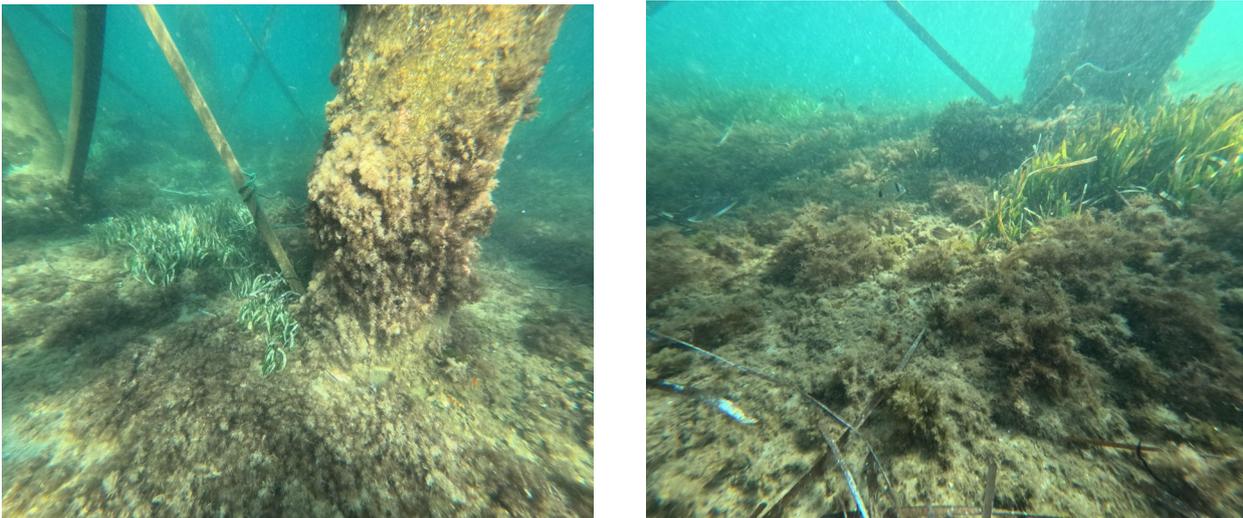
Reportage photo des piliers de soutènement du ponton de la Bouillabaisse (08 octobre 2023)
